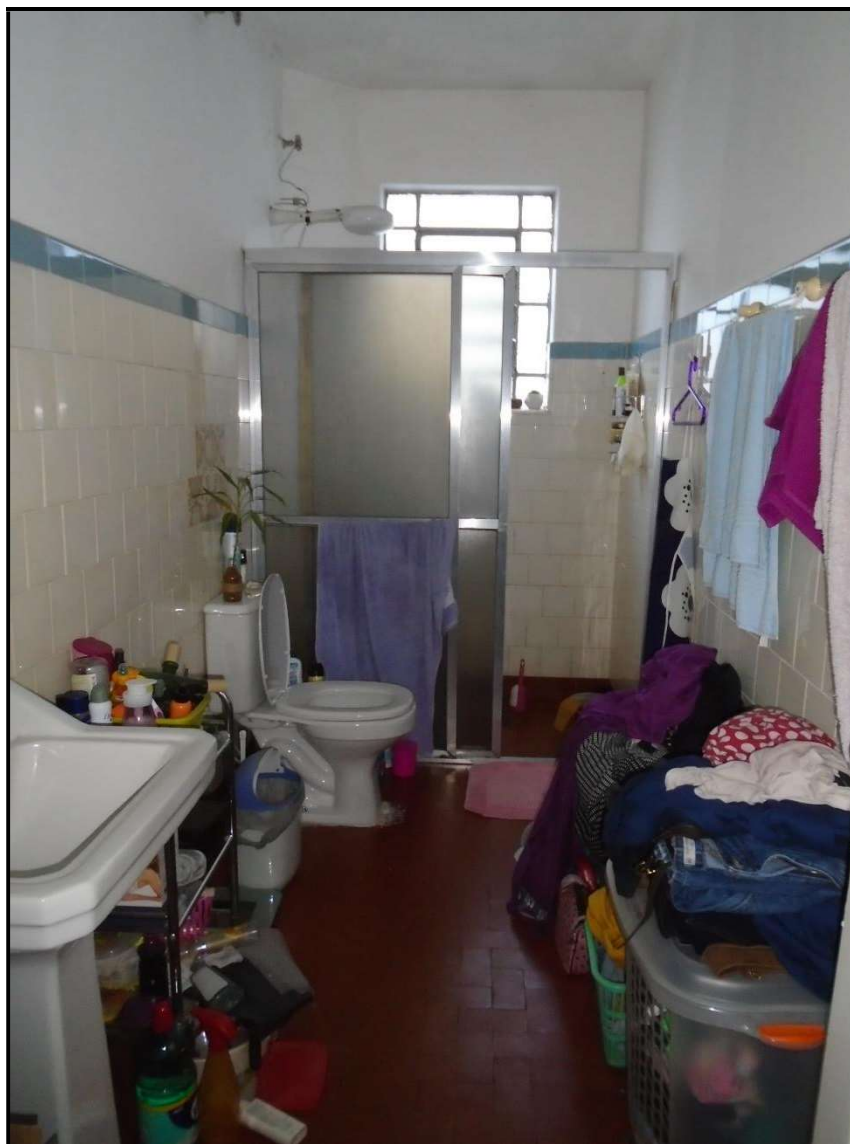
ASPECTO CARACTERISTICAS ORIGINAIS BANHEIRO.
